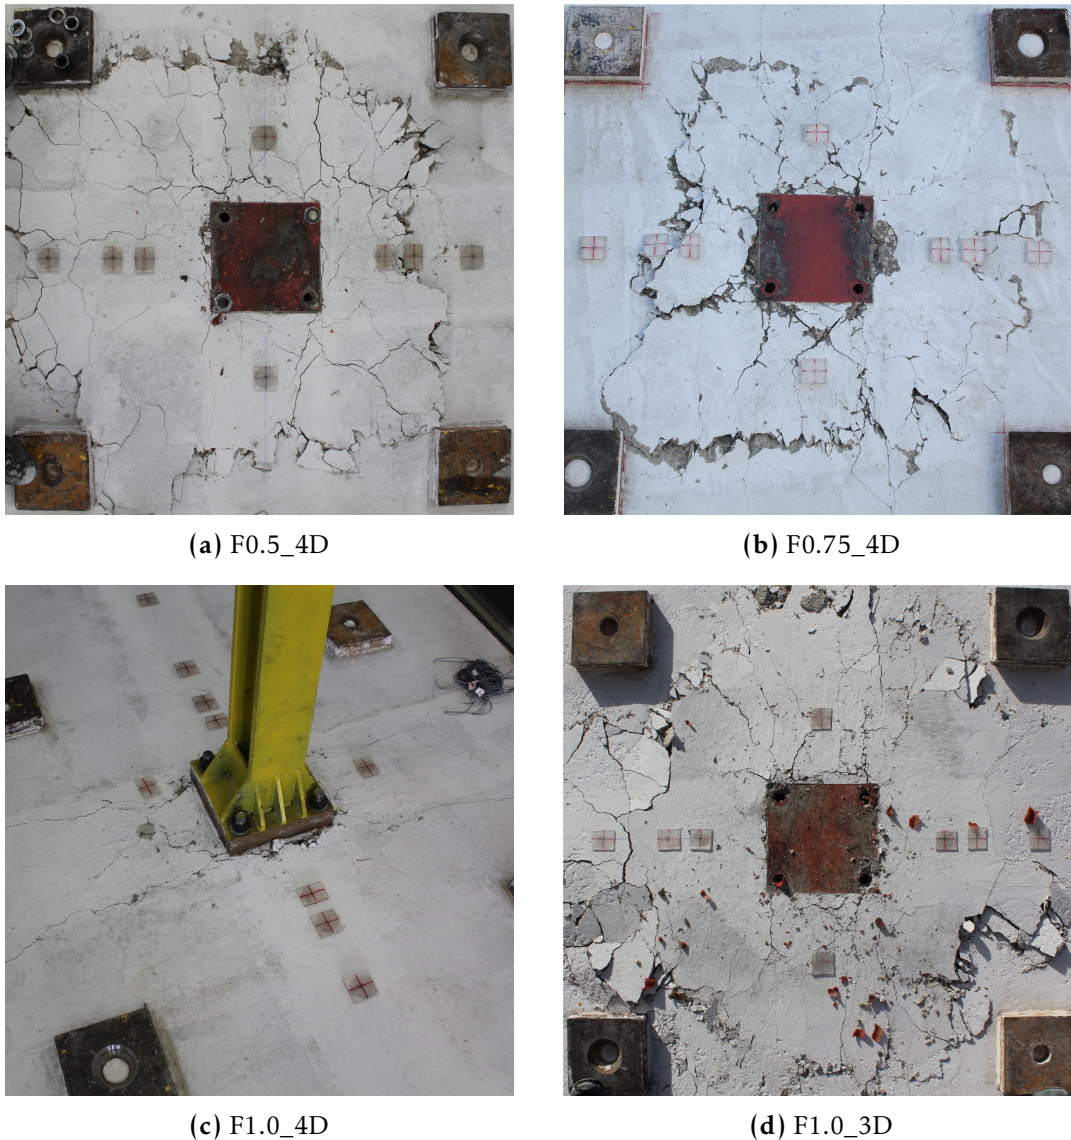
Vista da face superior dos modelos de laje, na zona do pilar, após os ensaios.
